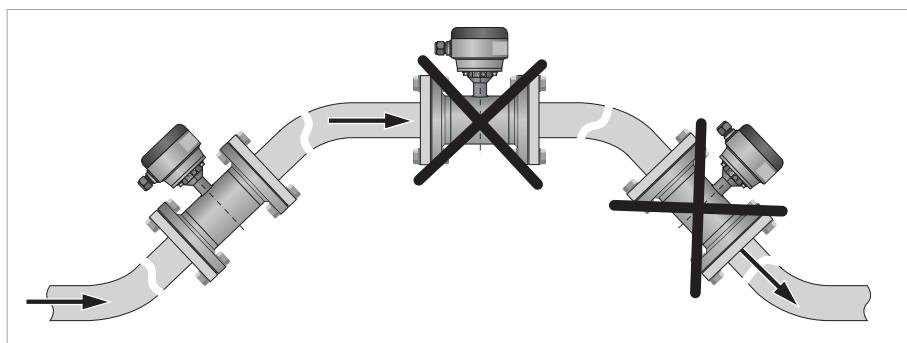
Монтаж в изогнутых трубопроводах
